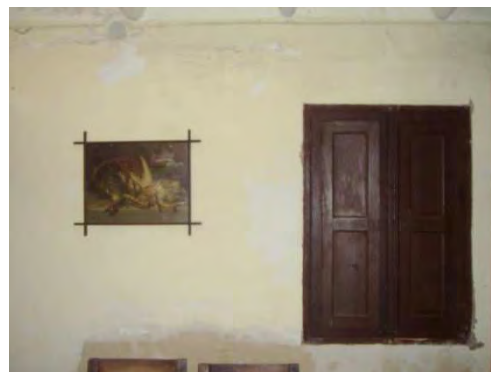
Cap. 6: Grietas horizontales y desprendimientos
